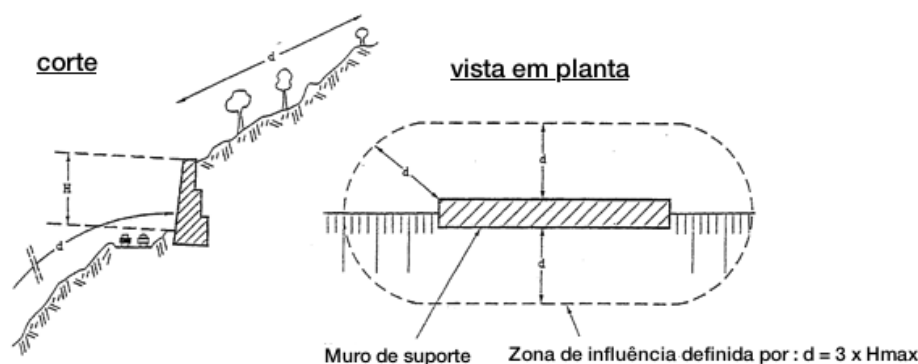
Esquema de vista em corte e em planta da área de influência de uma OC [6].
